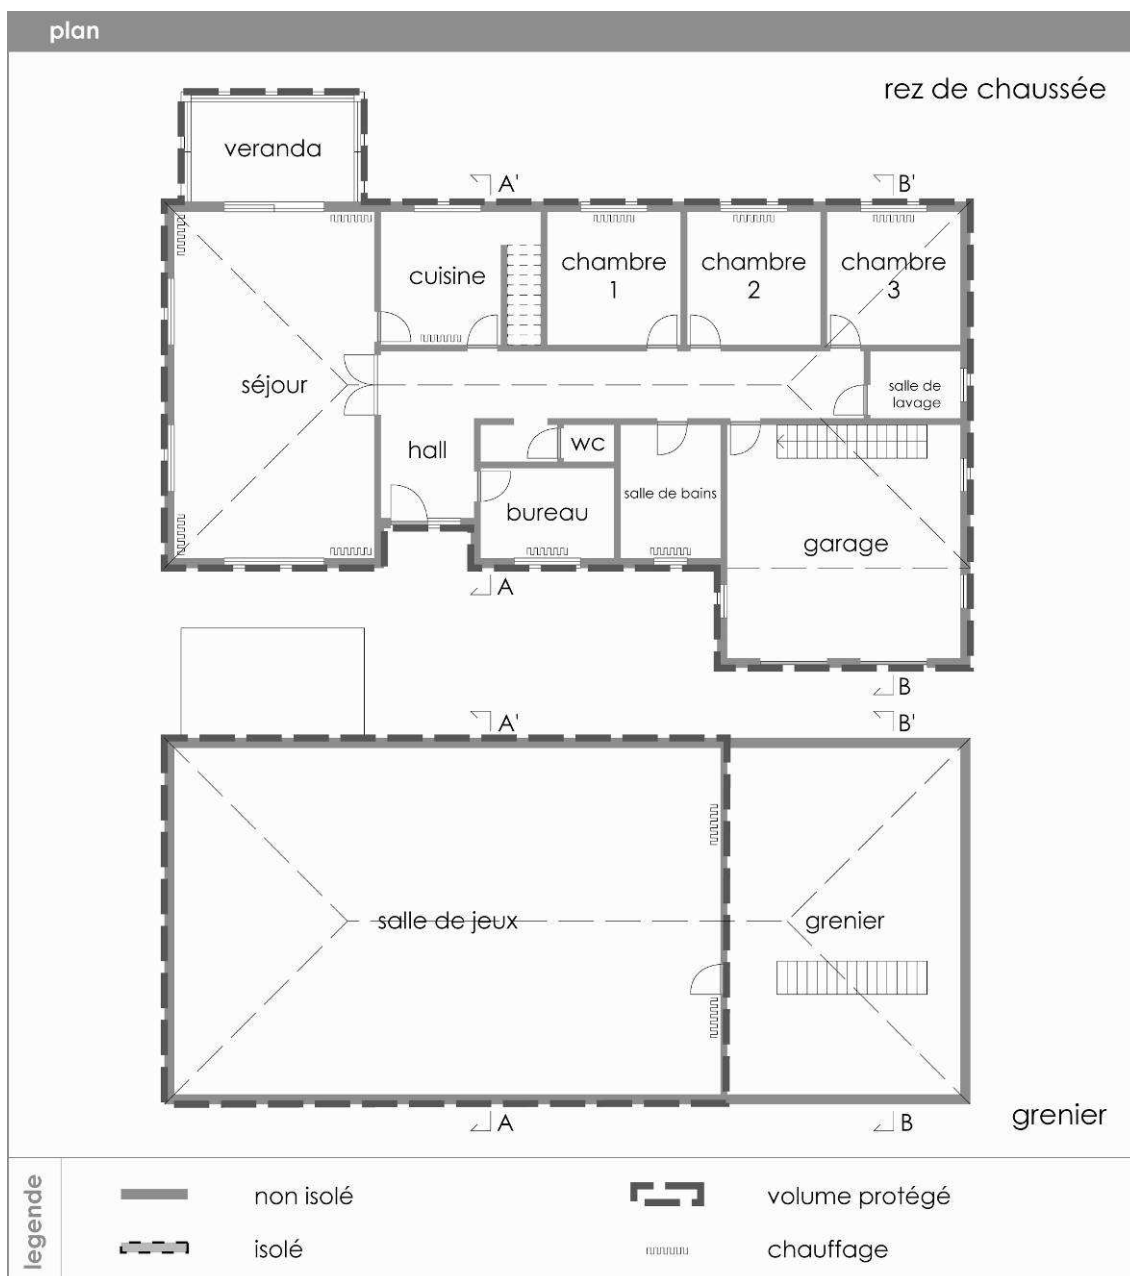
Plan au sol d'une villa 4 façades avec salle de jeux au grenier
